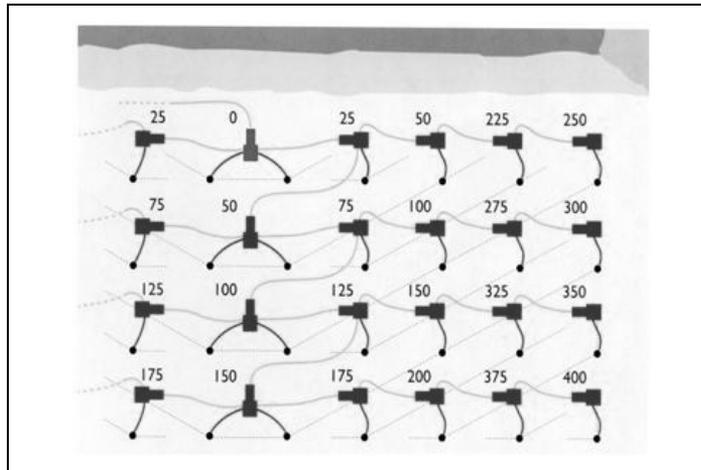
Configuração de malha regular de furação e sugestão de sequenciamento de detonação.
